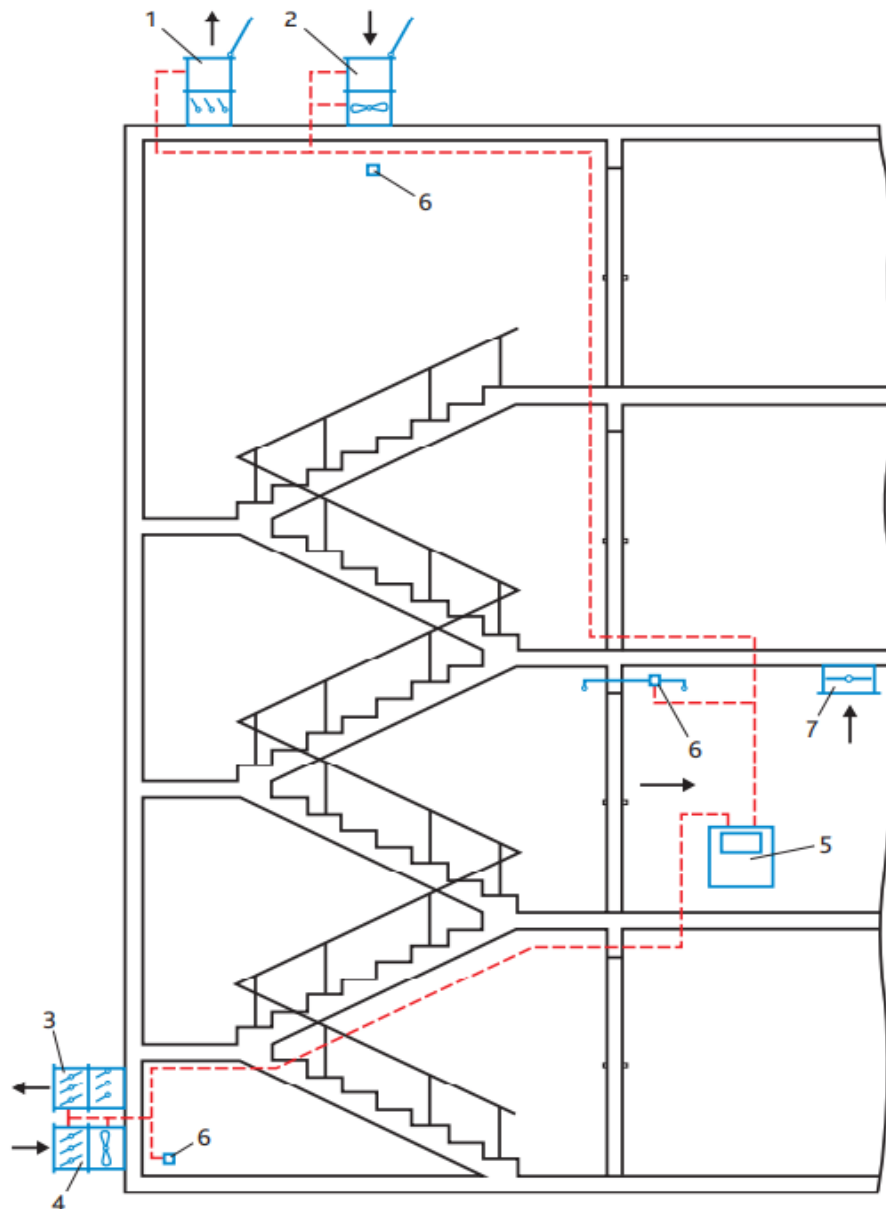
Лаборатория-макет лестничной клетки. 1 – кровельный клапан сброса давления; 2 – кровельная приточная установка подпора воздуха; 3 – стеновой клапан сброса давления; 4 – стеновая приточная установка подпора воздуха; 5 – пожарный прибор управления, 6 – датчики дифференциального давления; 7 – клапан вытяжной противодымной системы вентиляции
